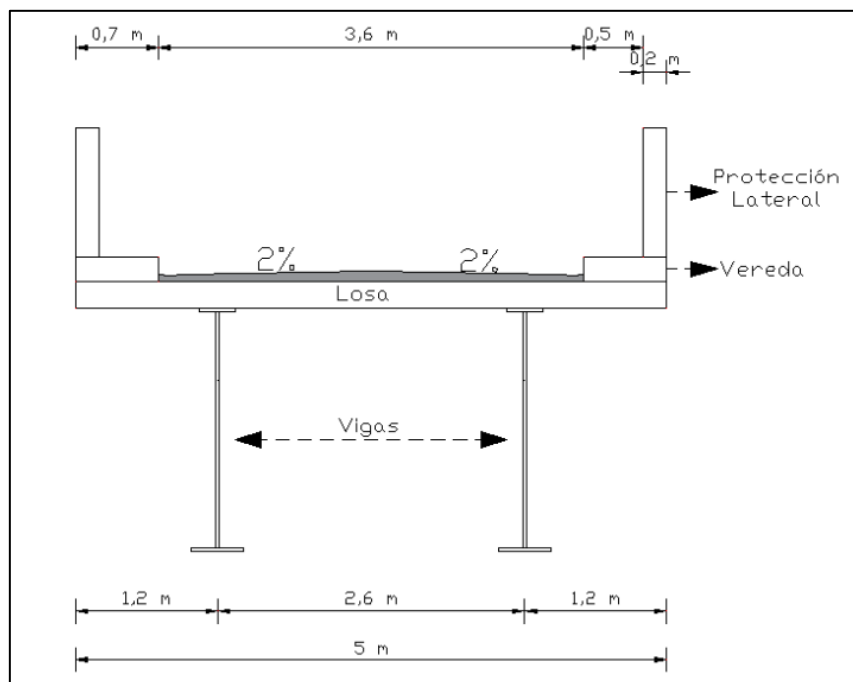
Sección Transversal del puente sobre el Río Chicaña
